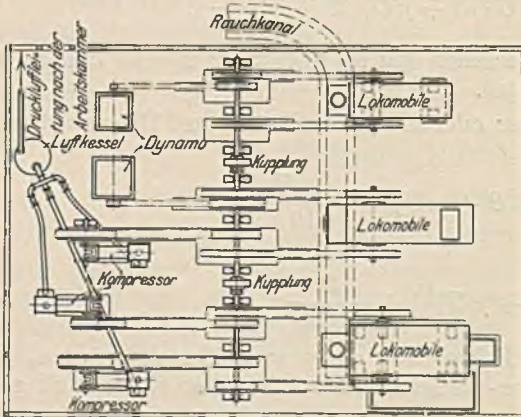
Druckluftherzeugungsanlage mit Riemenkompressoren, die von einer gemeinsamen Vorlegewelle aus angetrieben werden.
